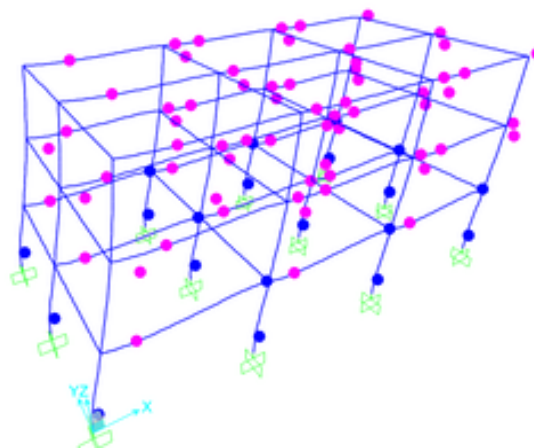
Zonas de formación de rótulas plásticas en un pórtico de concreto armado.
